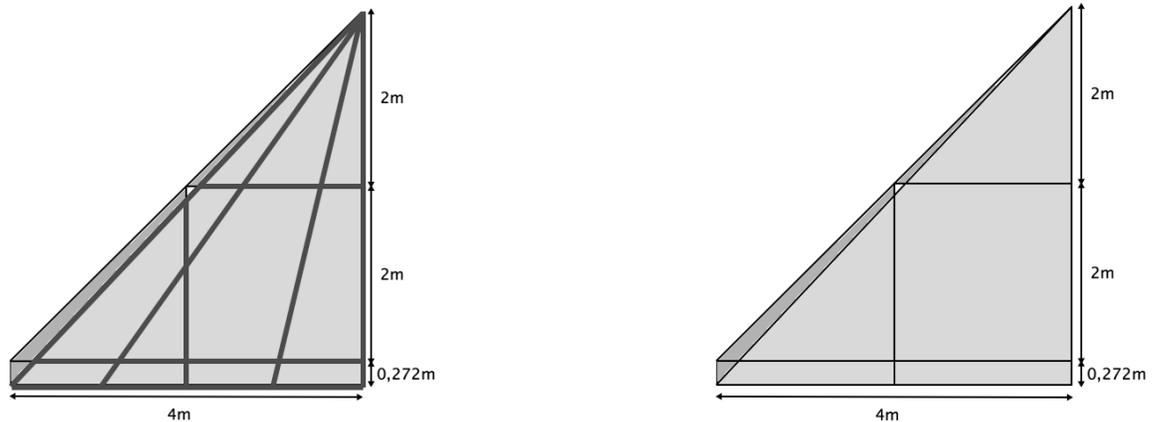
Panel Techo estructural (izq) y vista externa (der)
